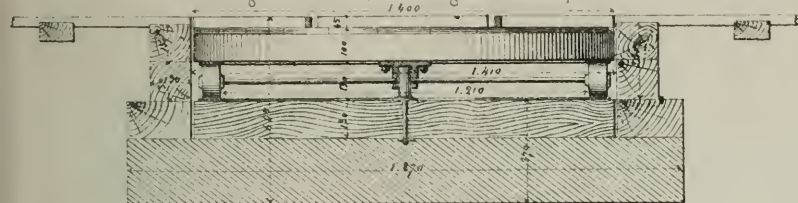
Elevation, coupe de la crapaudine, à 0,20 p.m
